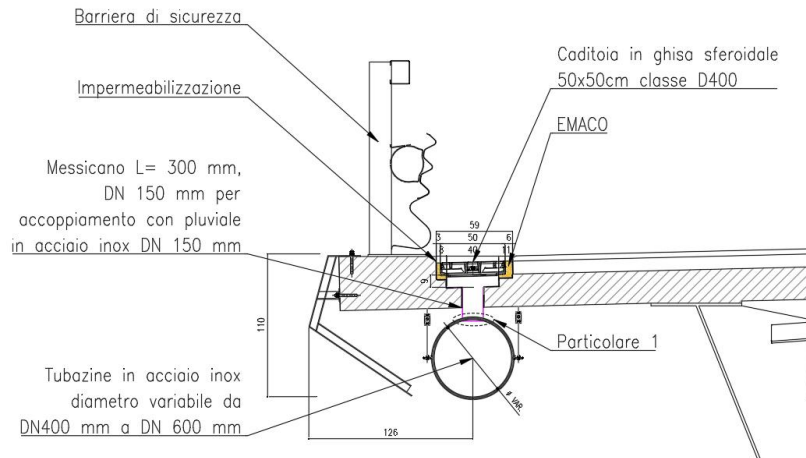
Particolare tipologico di captazione delle acque meteoriche e sezione tipo di scarico nel collettore principale in viadotto
